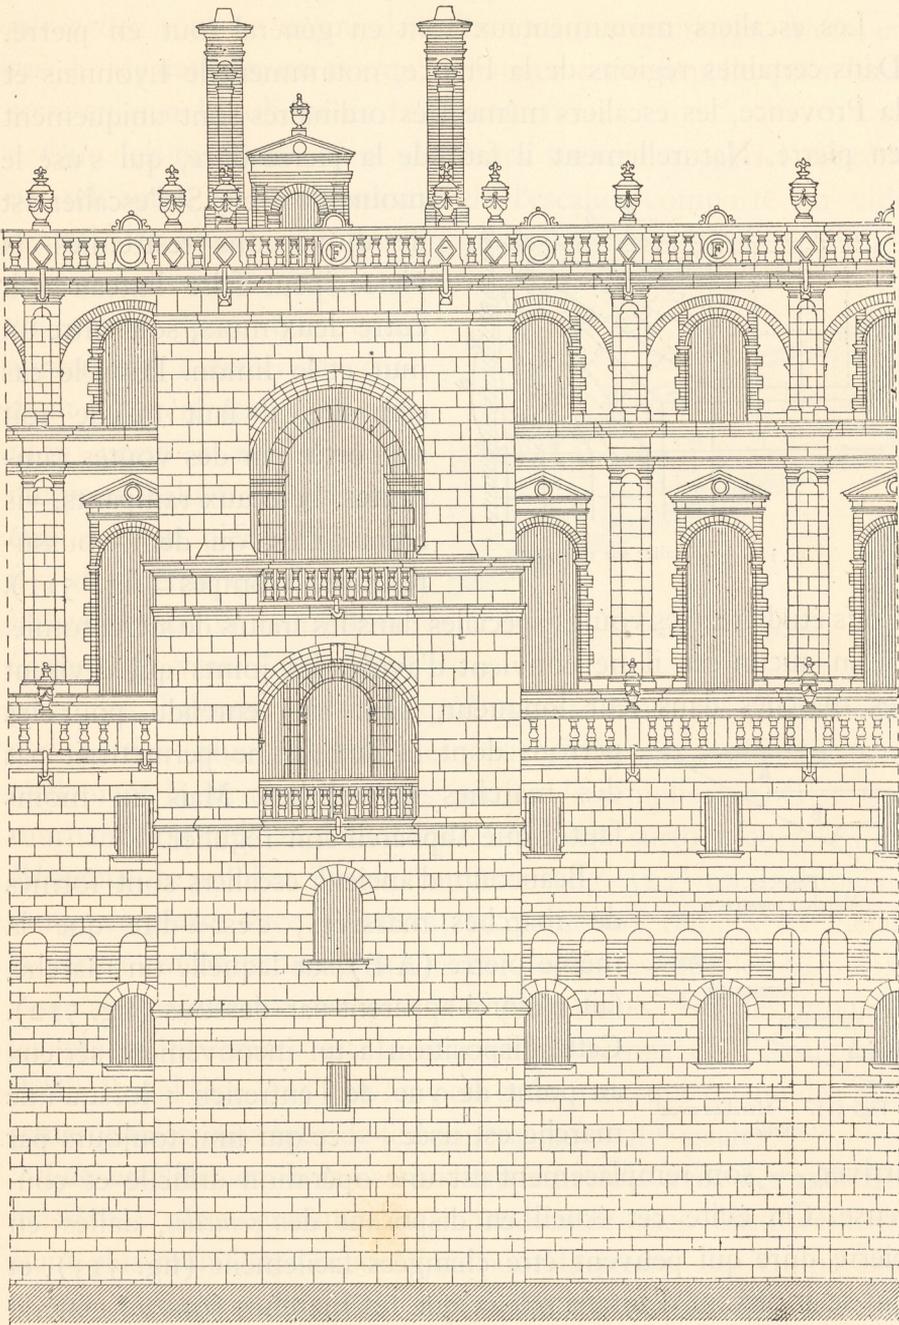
Façade de l'escalier du château de Saint-Germain.
